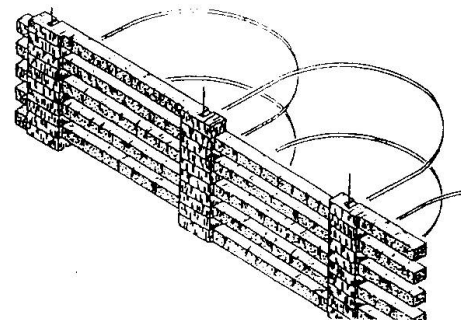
STRUCTURE: BÉTON AJOURÉ/ÉTRIERS
